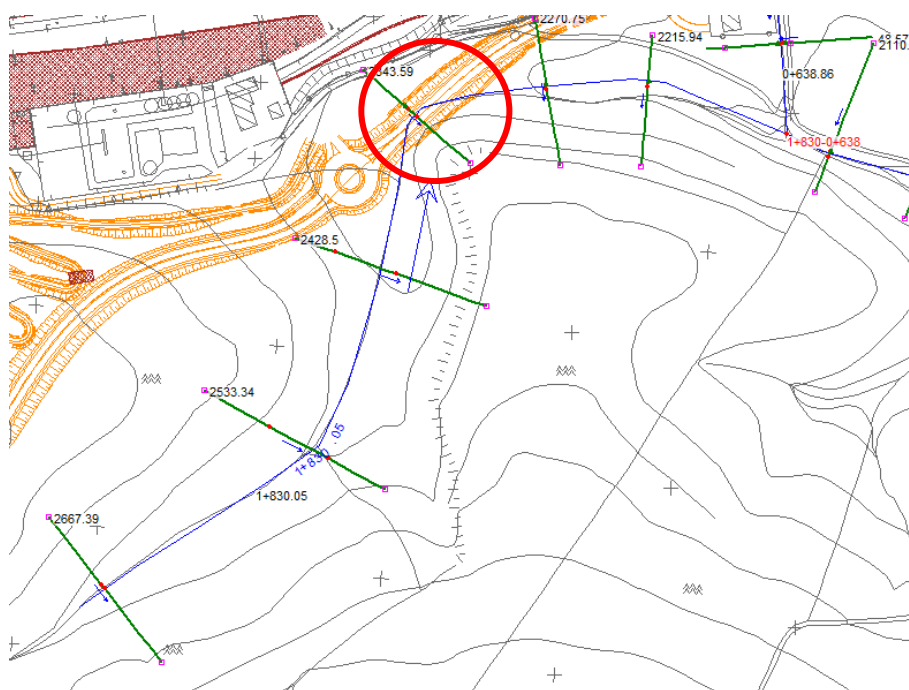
Planimetria Hec ras – sovrapposizione SDF – linea di progetto
